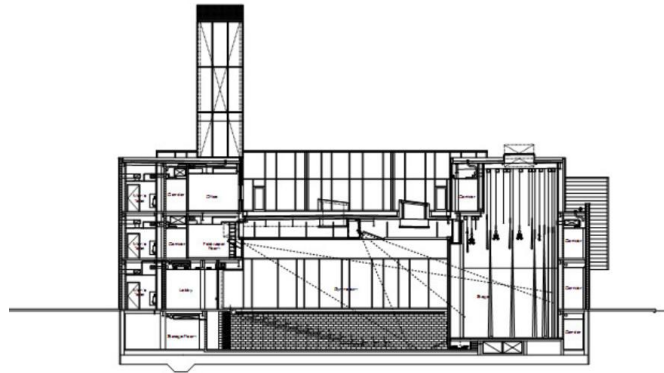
19 Third Plan Garry Comer Youth Center
